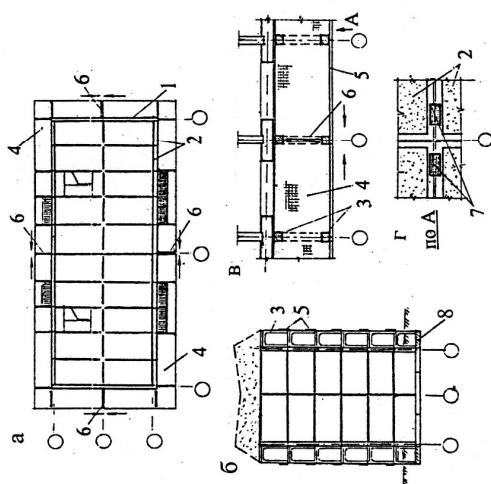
Реконструкция крупнопанельного пятиэтажного дома с предварительно стягиваемыми поясами
